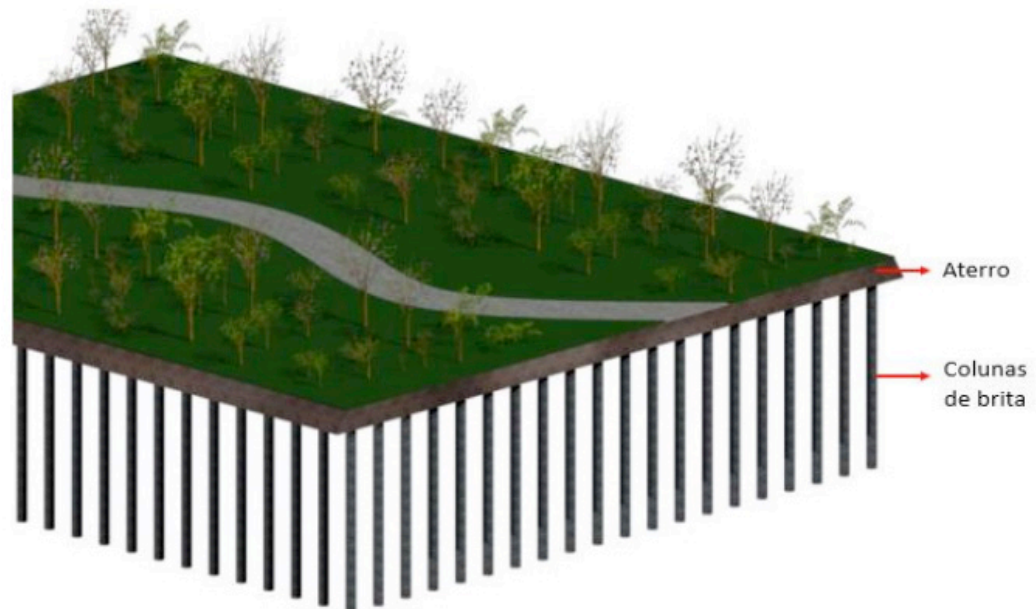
Geometria 3D – Canteiro central (Adaptado de Ignacio, 2016)
